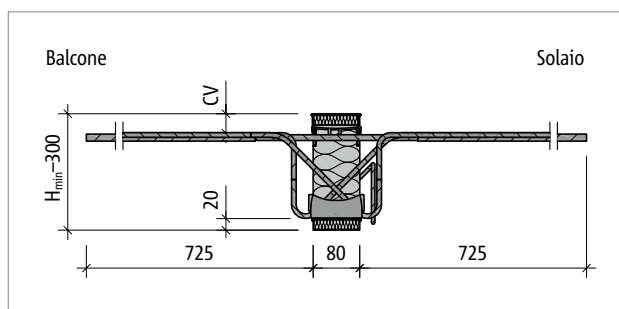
Schöck Isokorb® T tipo KL-M4-VV1: sezione del prodotto
